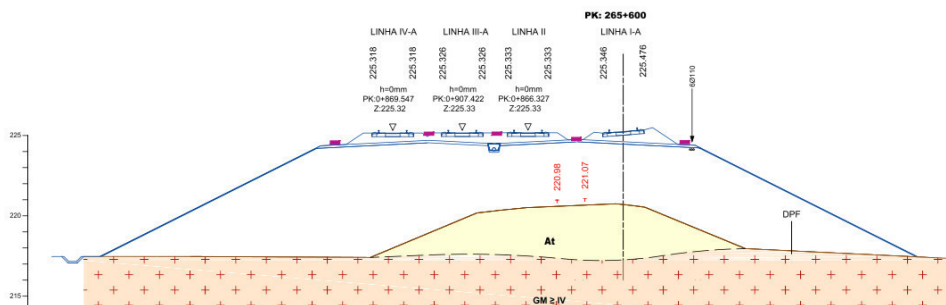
Perfil Geotécnico transversal Pk 265+600 [36]
